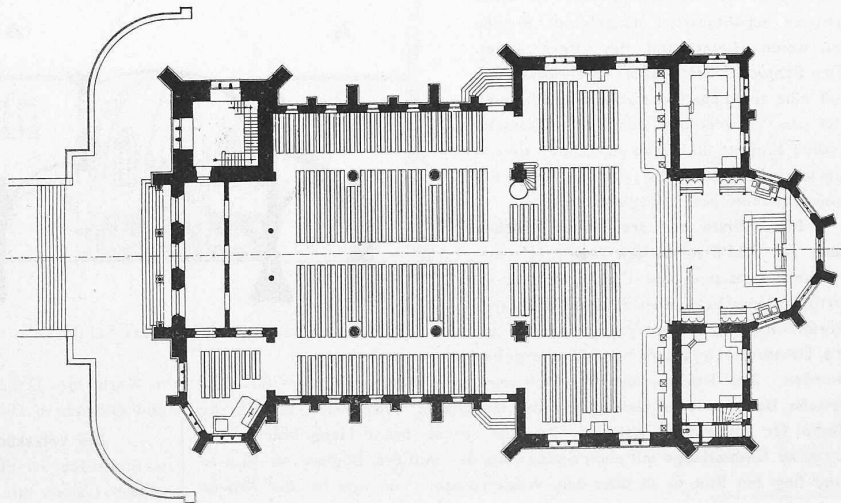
Grundriss der St. Michaelskirche in Zug. — Masstab 1:600.
